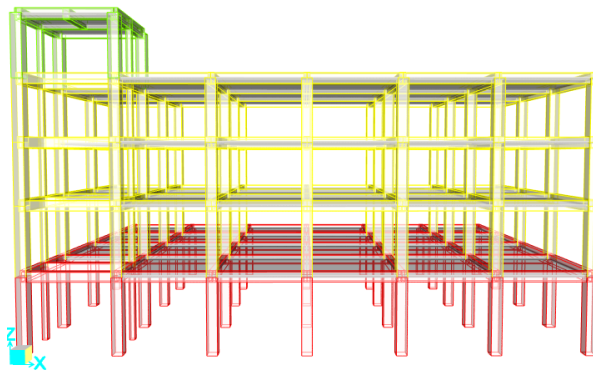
Denah Model Struktur Rumah Sakit L3
